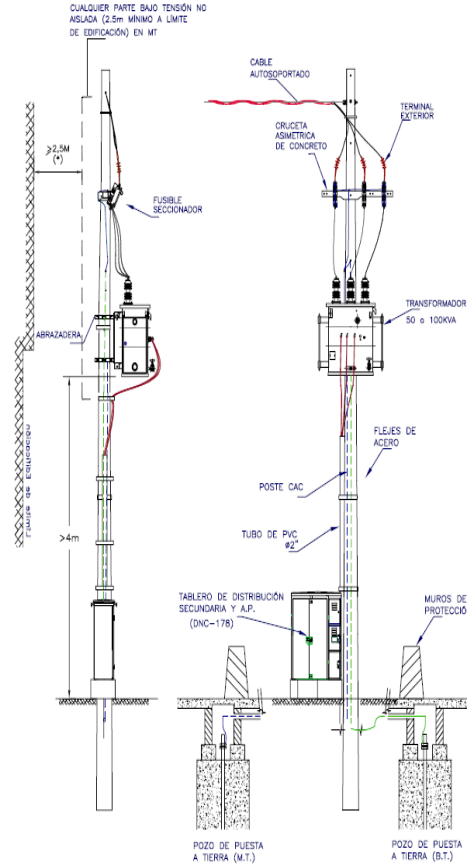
Montaje de los elementos estructurales que componen las SAM
